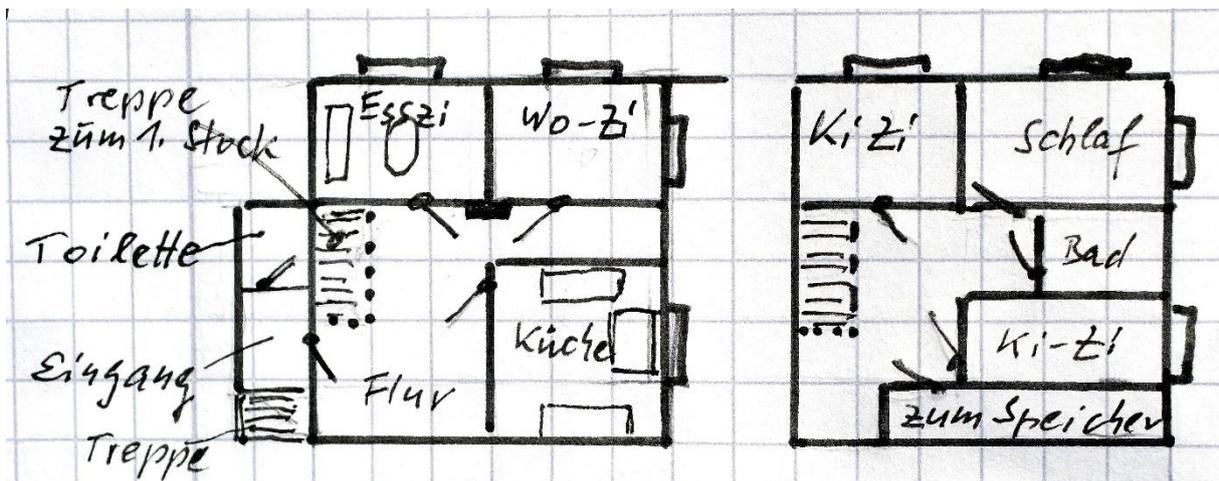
Grundriss der beiden Etagen in unserem Haus in der Bahnhofsiedlung in Hirschfelde. Links: Erdgeschoss, rechts: Obergeschoss
